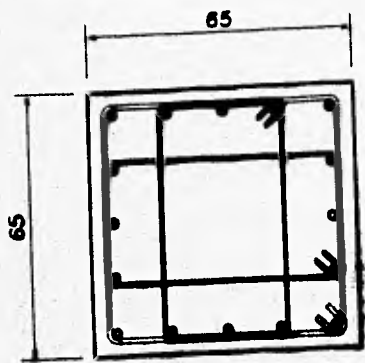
REFUERZO TRANSVERSAL EN ZONAS CENTRALES DE COLUMNAS, MODELO 2, Q=4
